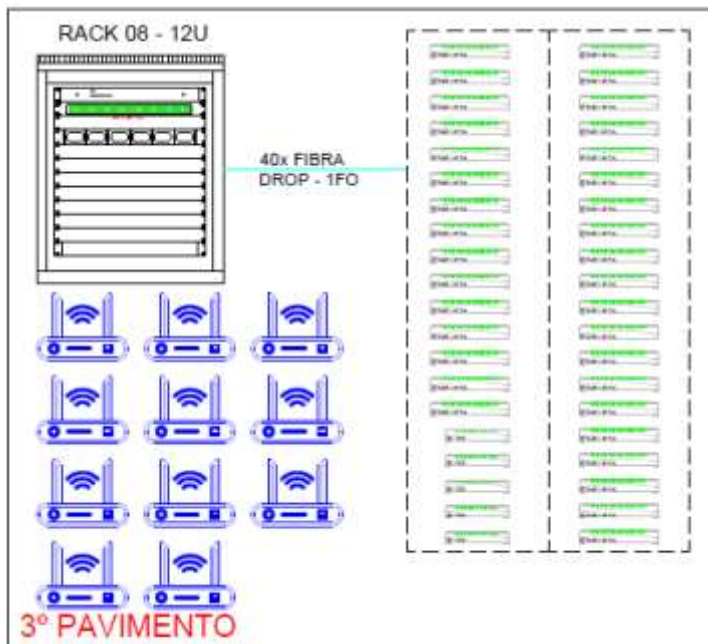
Infraestrutura considerada em cada rack de rede de consolidação;
